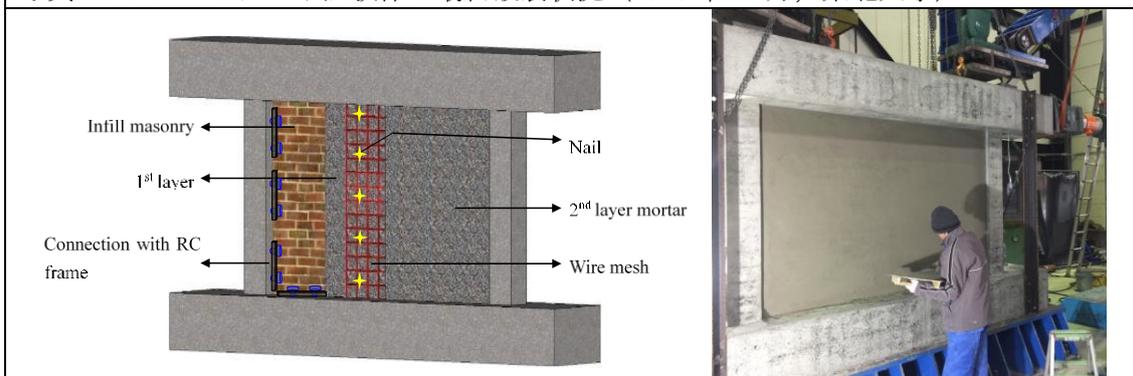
フェロセメント補強の概要（左）と日本での施工状況（右）
